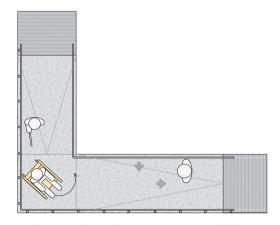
Vista en planta de una rampa accesible en esquina.
